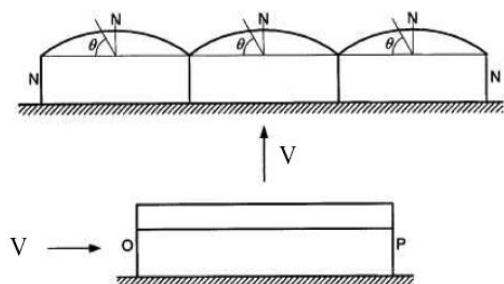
Zonificación para paredes y cubiertas de un invernadero multinave, con canalón (viento paralelo).
